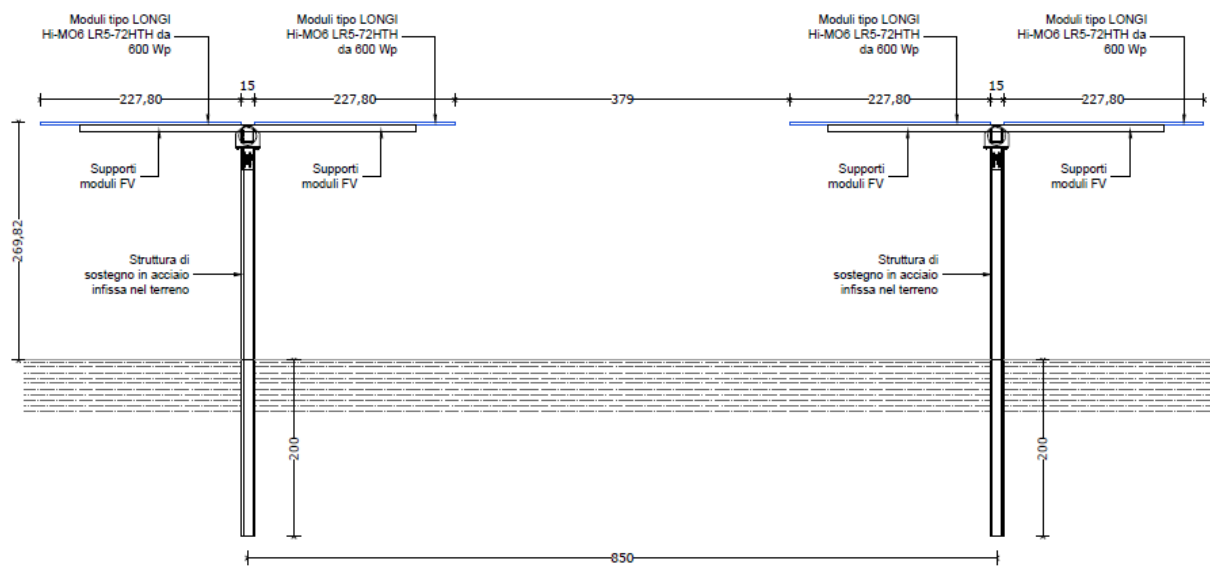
Sezione tipo di installazione dei moduli fotovoltaici.
